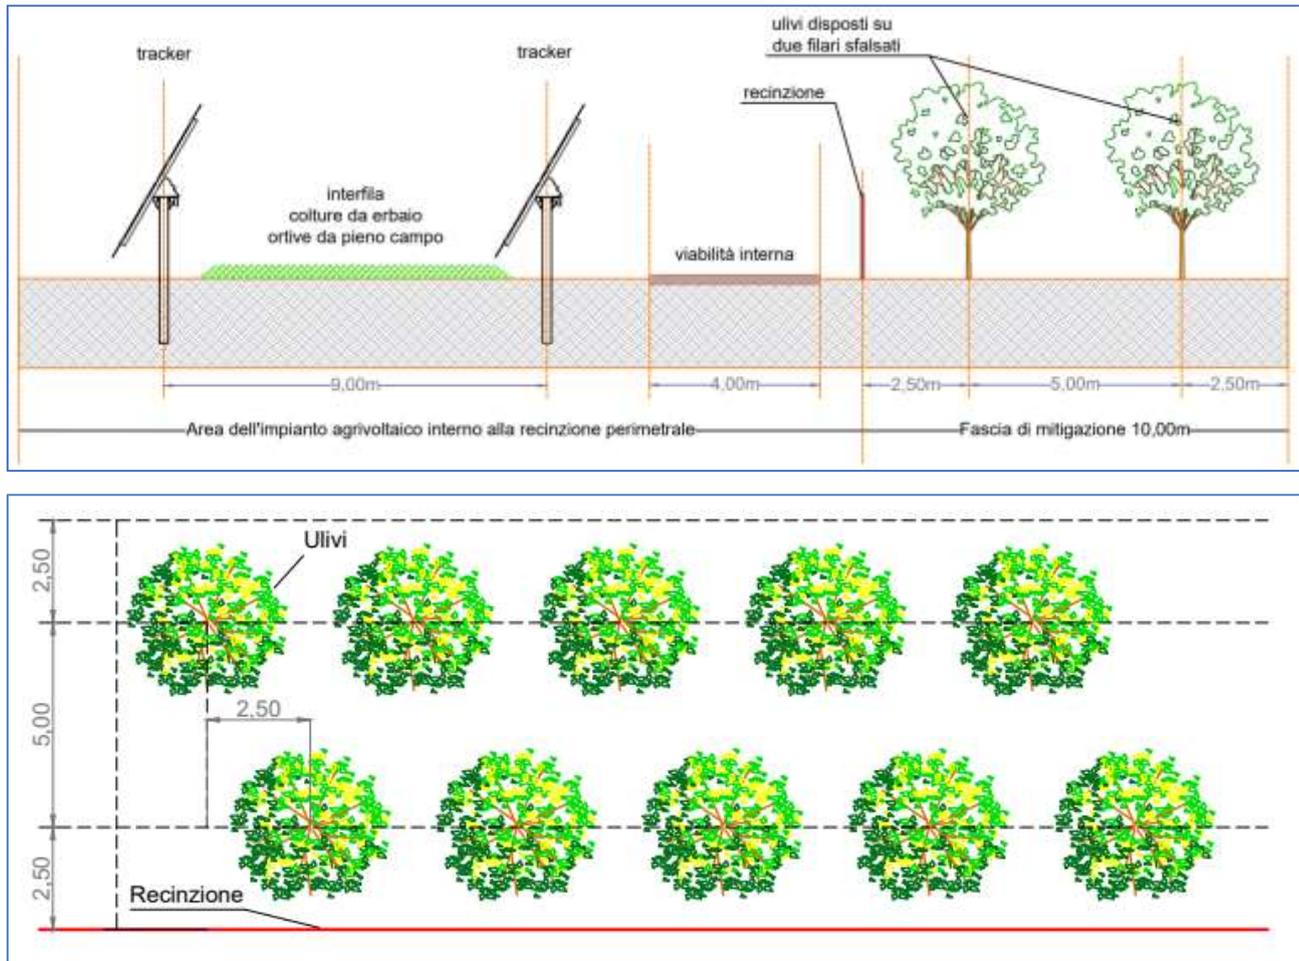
Fasce di mitigazione, in sezione trasversale e in pianta.
